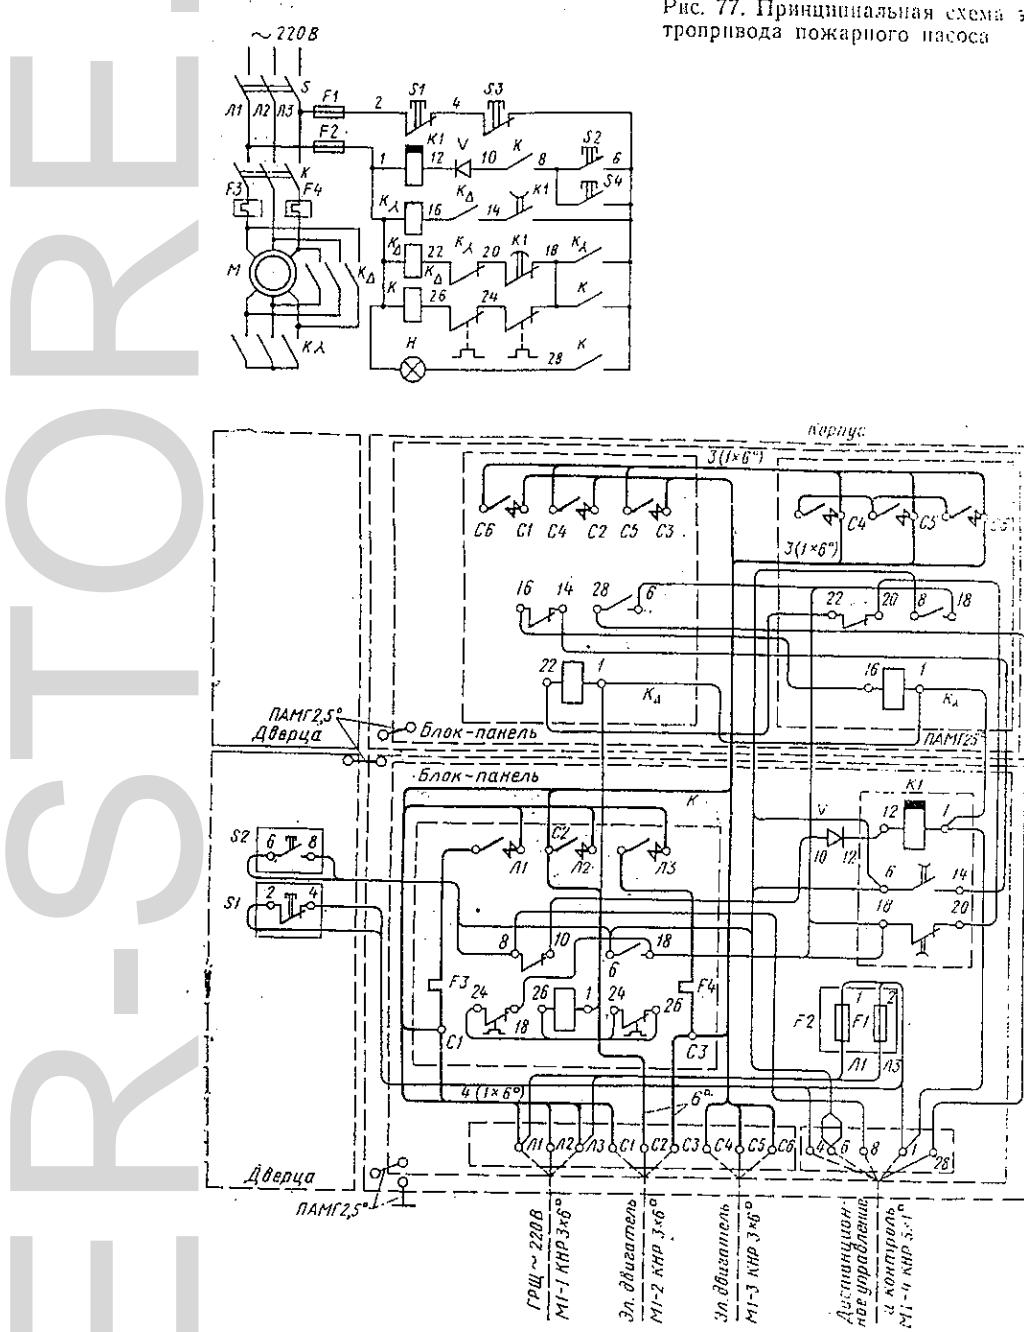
Монтажная схема щита питания электродвигателя пожарного насоса
